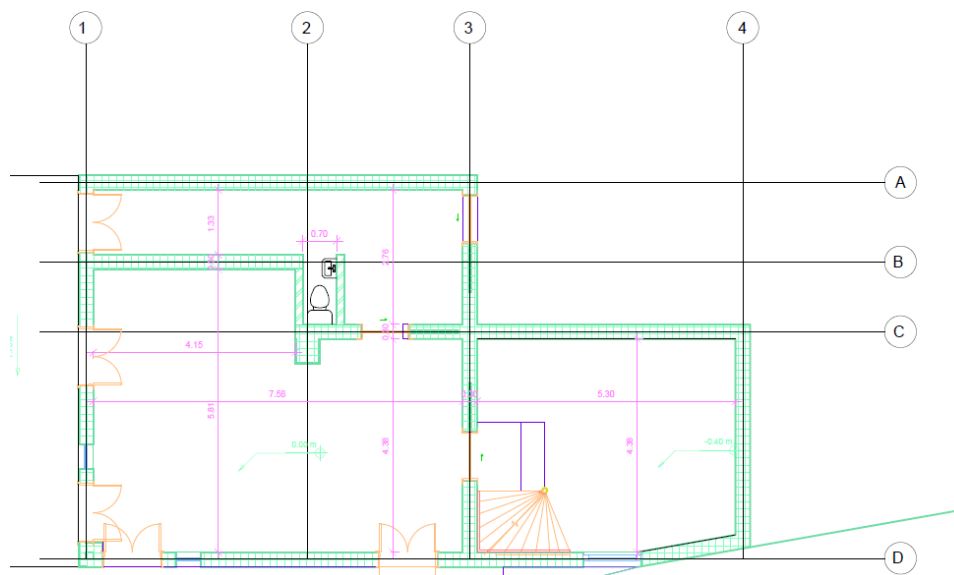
Plano levantamiento OXXO SAN LUIS. Fuente propia.
